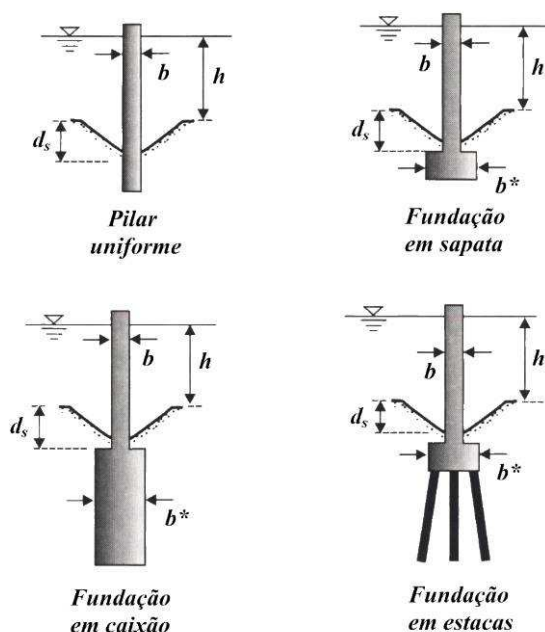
Exemplos de pilares não uniformes e comparação com um pilar uniforme (adaptado de MELVILLE E COLEMAN 2000).
